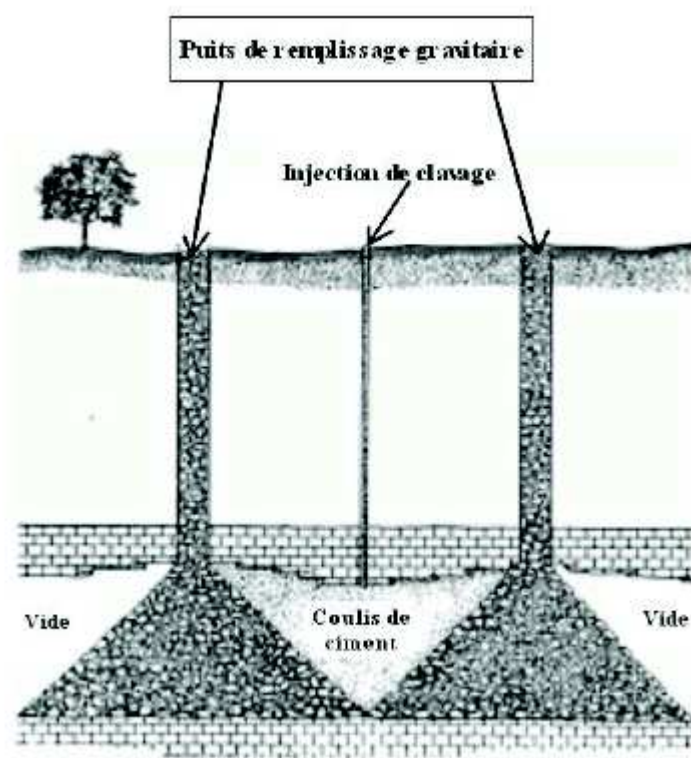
remblaiement et clavage d'une carrière – source : IGC.
